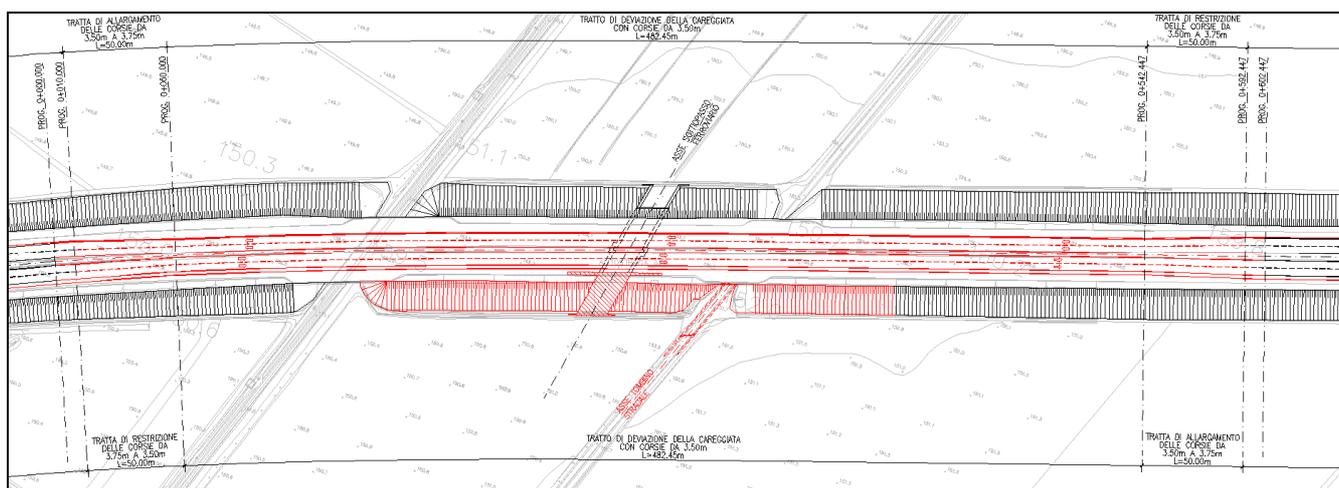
Planimetria fasi realizzative dell'opera. Fase 4
